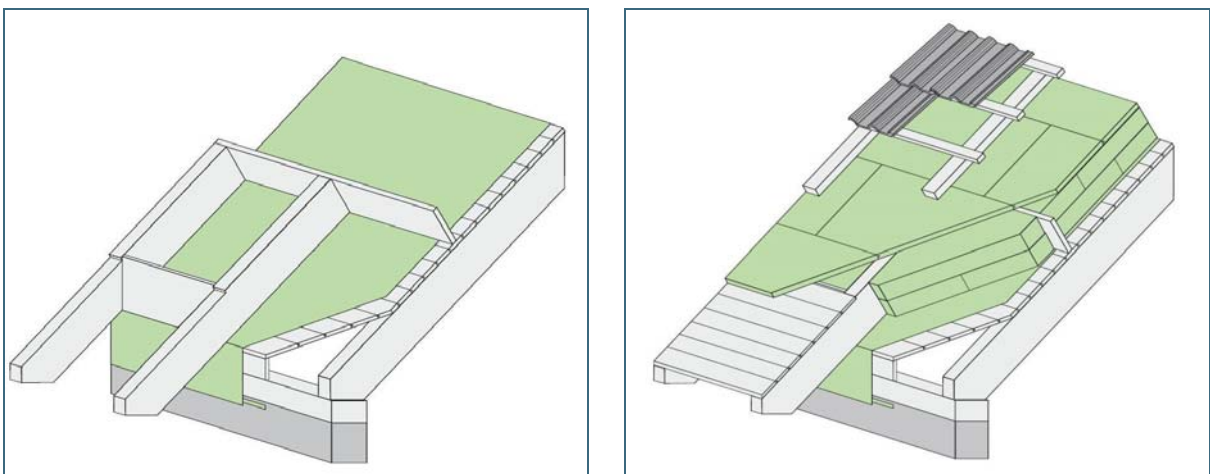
und 9: Nach dem Aufbringen einer Dampfbremse werden Hilfssparren auf die vorhandenen Sparren aufgesetzt, mit Dämmstoff ausgefüllt und mit Aufsparrendämmung ergänzt (hier Holzfaserplatten). Gerade bei einer geplanten Fassadendämmung kann auf diese Weise das Dach hochwertig gedämmt und der Dachüberstand einfach vergrößert werden.
